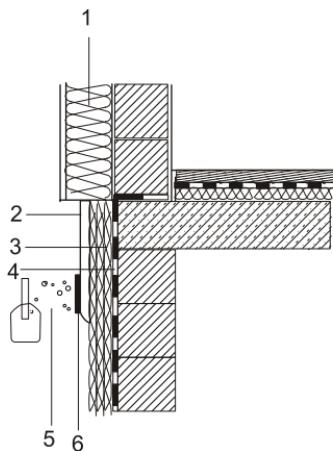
Защита утеплителя цоколя от воздействия окружающей среды: 1 — система наружного утепления стены; 2 — цокольная штукатурка; 3 — экструдированный пенополистирол; 4 — гидроизоляция фундамента; 5 — гравий; 6 — гидроизоляция битумной мастикой
